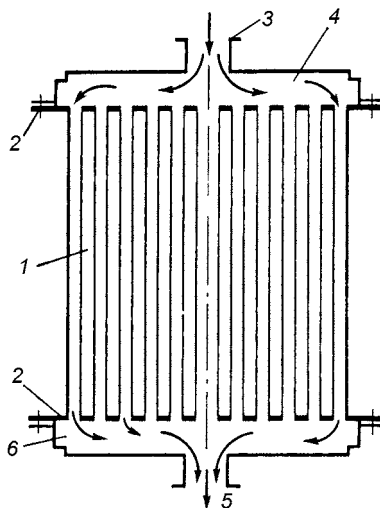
Гладкотрубний калорифер: 1 — нагрівні труби; 2 — трубні дошки; 3 — вхідний штуцер; 4 — розподільча коробка; 5 — вихідний штуцер; 6 — збірна коробка
